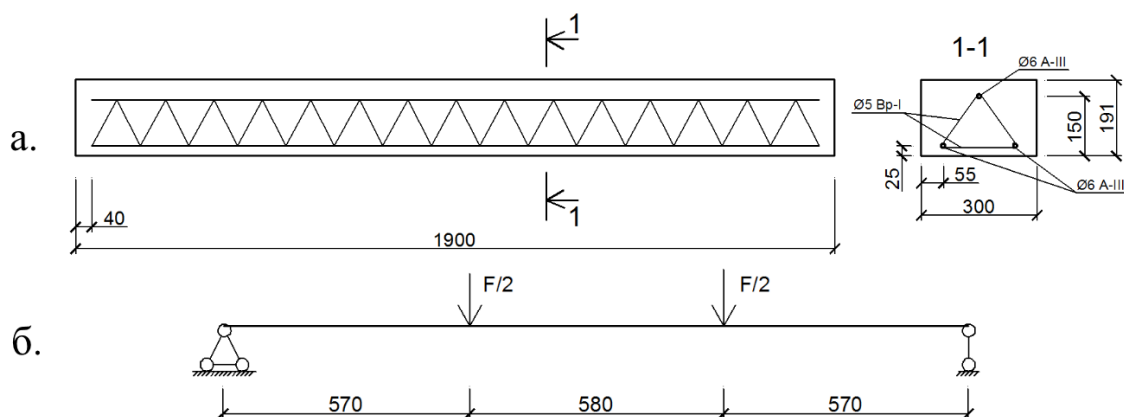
а – размеры и схема армирования испытываемых образцов-балок, б – расчетная схема
